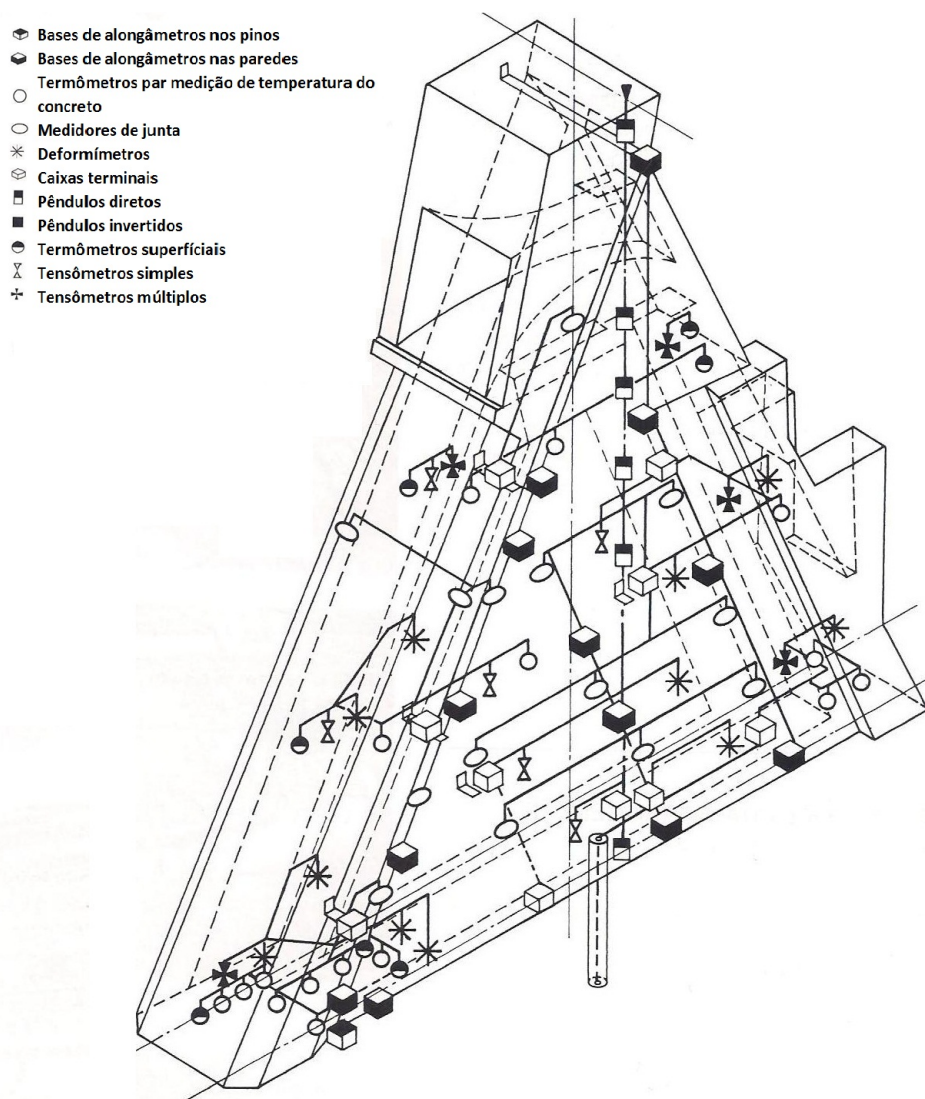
INSTRUMENTAÇÃO TÍPICA DA BARRAGEM DE GRAVIDADE ALIVIADA
